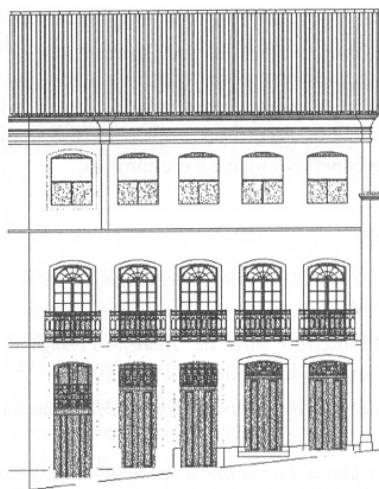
Sobrado à rua do Giz, 117 – Fachada (LIMA et al, 2004, p. 131).
